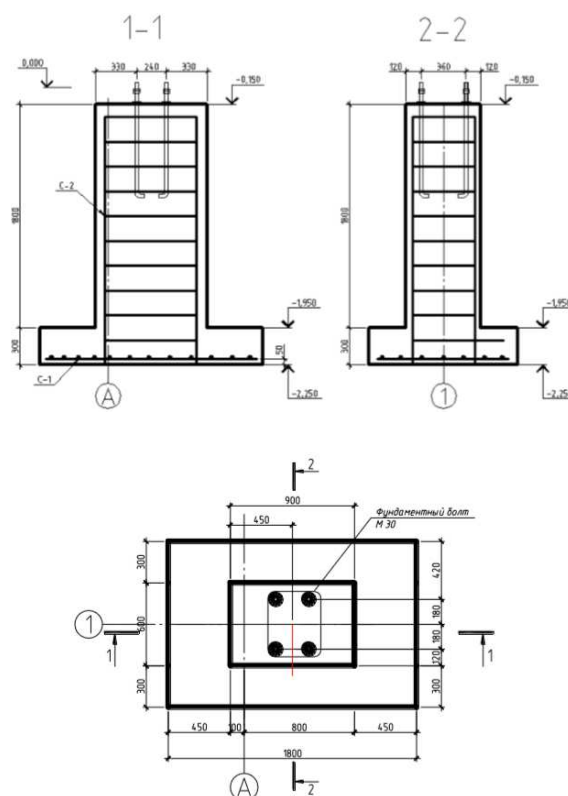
Схема к расчету арматуры плитной части фундамента
